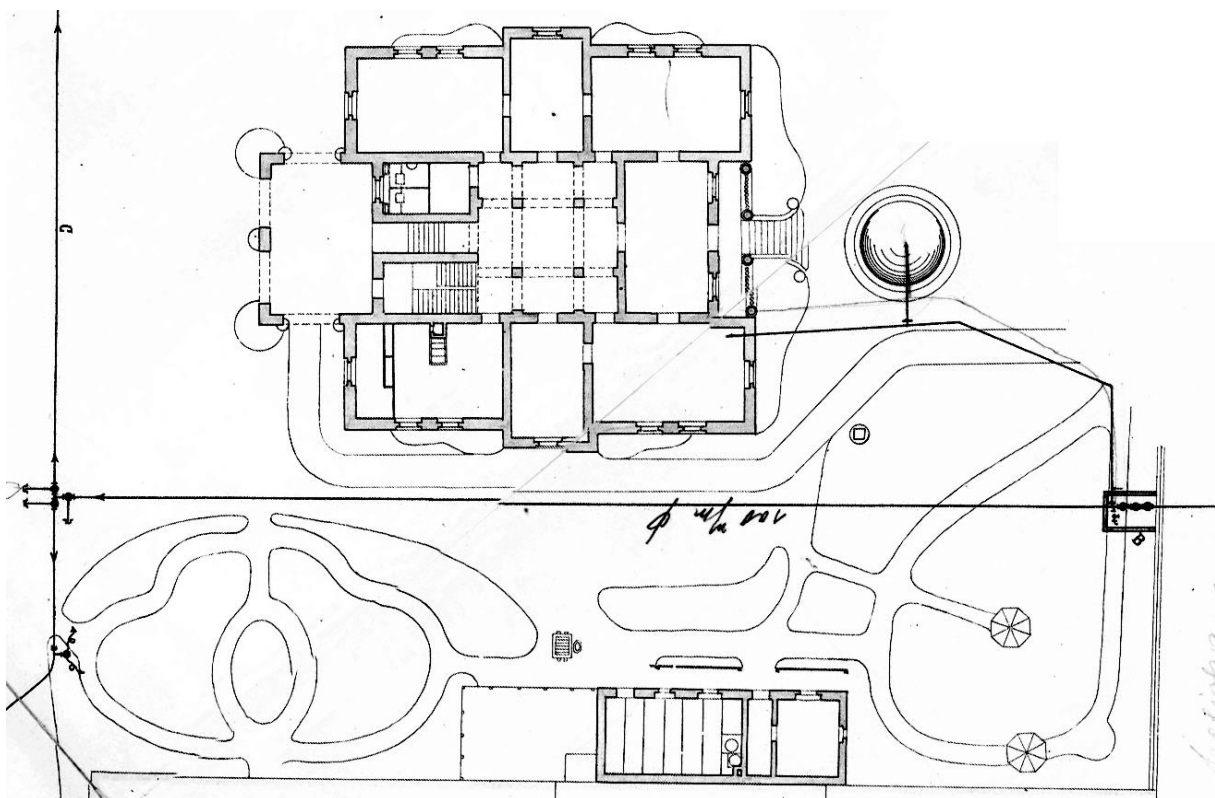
Plan der Villa Franz mit dem Vorgarten aus dem Jahr 1902
